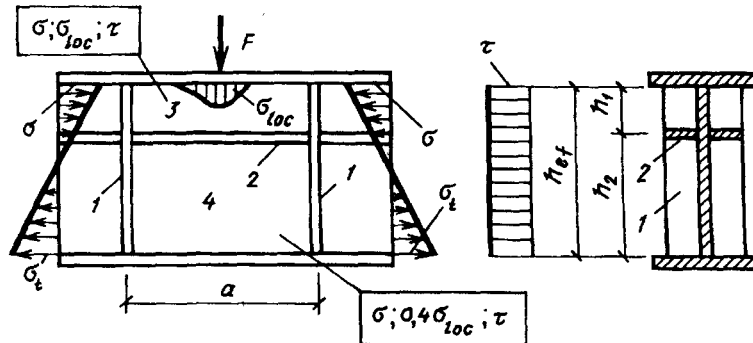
Схема балки, укрепленной основными поперечными и продольными ребрами жесткости
